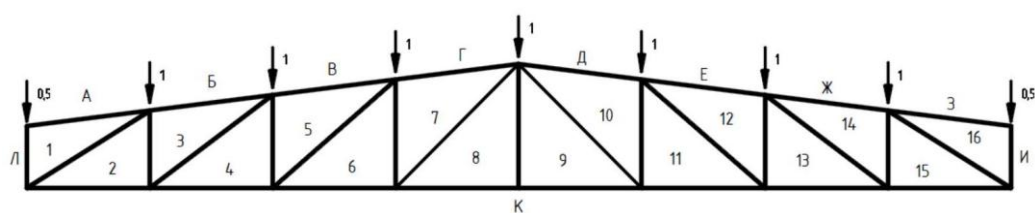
Схема вузлових навантажень на кроквяну ферму
